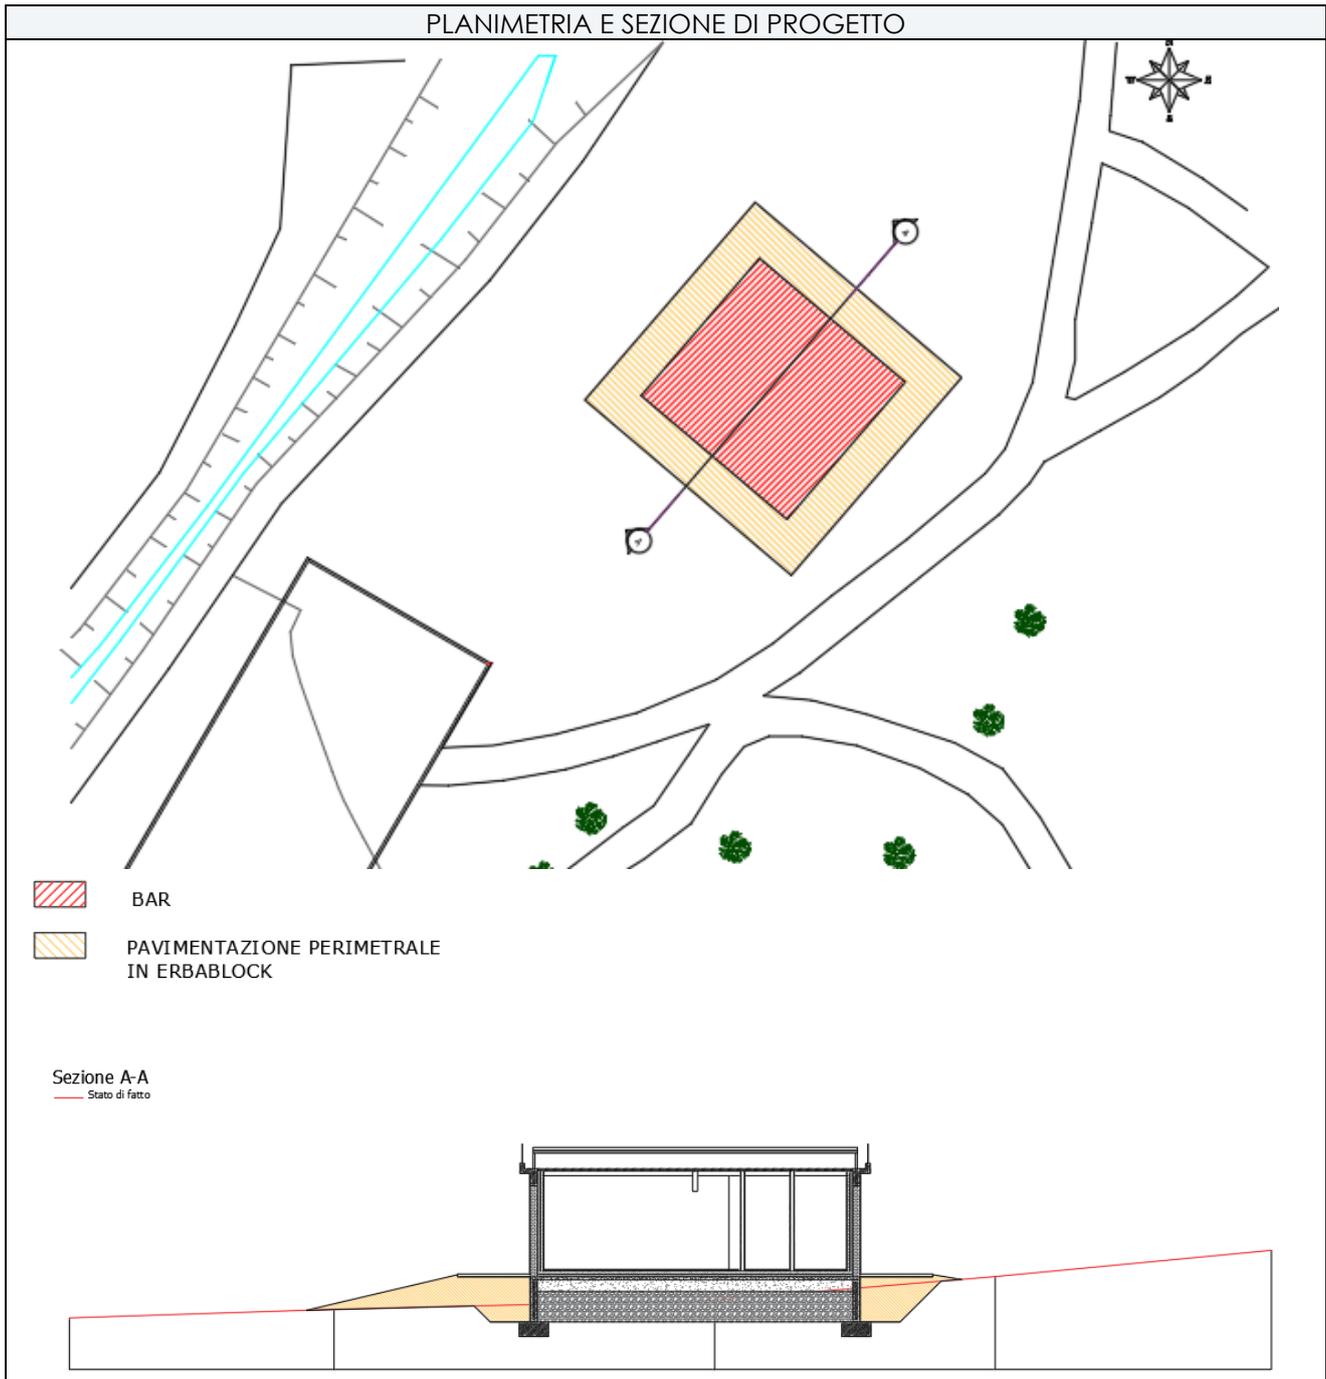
Prospetto dello stato di progetto (fonte elaborati a cura dell'Ing. Comincini)
